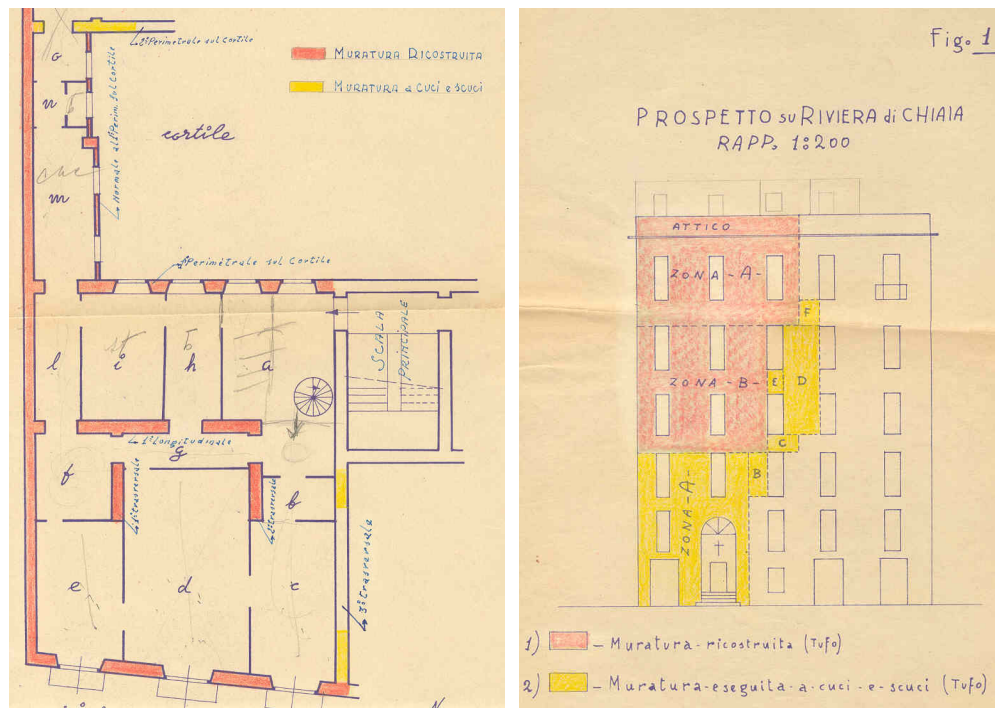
Pianta e prospetto degli interventi di ricostruzione.
